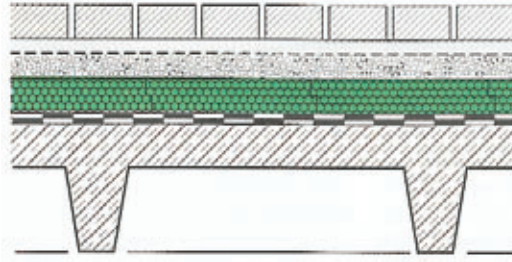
Schichtaufbau des Parkdecks mit Betonverbundsteinpflaster, P 6.
